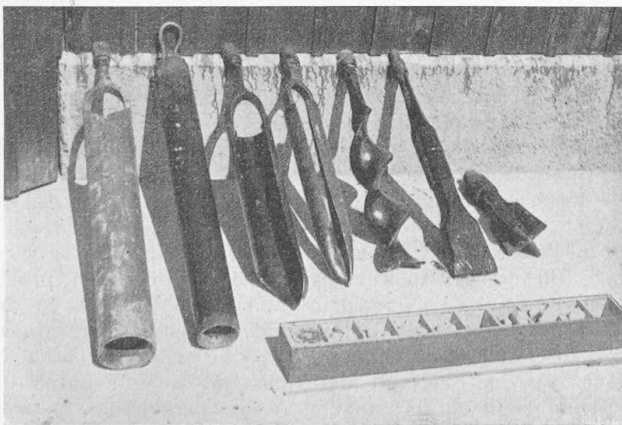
Bisherige Sondierwerkzeuge mit Materialproben-Kistchen.
